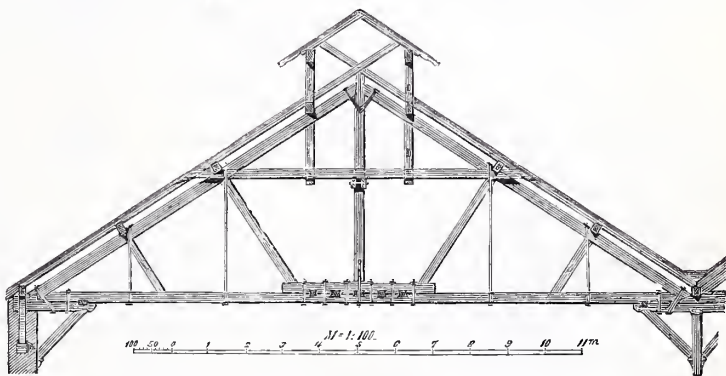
Dachgebünde mit einer hölzernen und vier eisernen Hängesäulen.
